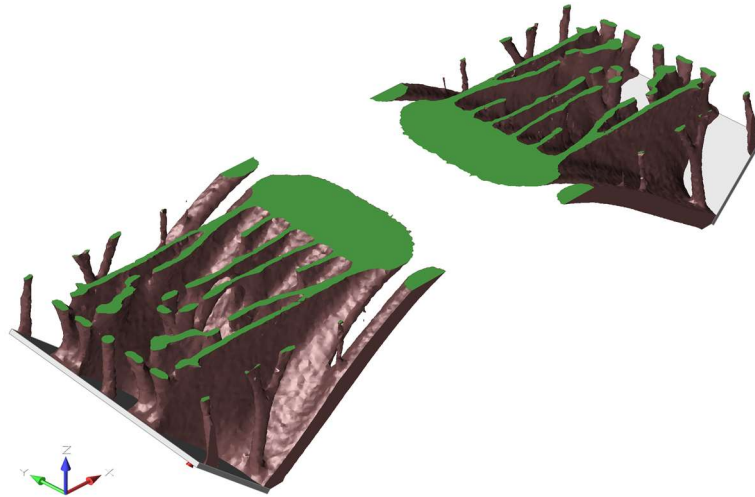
3D-Brücke horizontaler Schnitt -0,5 m
